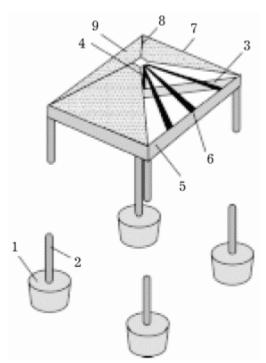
Шатровый навес: 1 — бетонный стакан; 2 — опорные столбы; 3 — крестовина; 4 — подпорный столбик; 5 — карнизная доска; 6 — стропила; 7 — кровельная доска; 8 — накладка; 9 — плашка.
